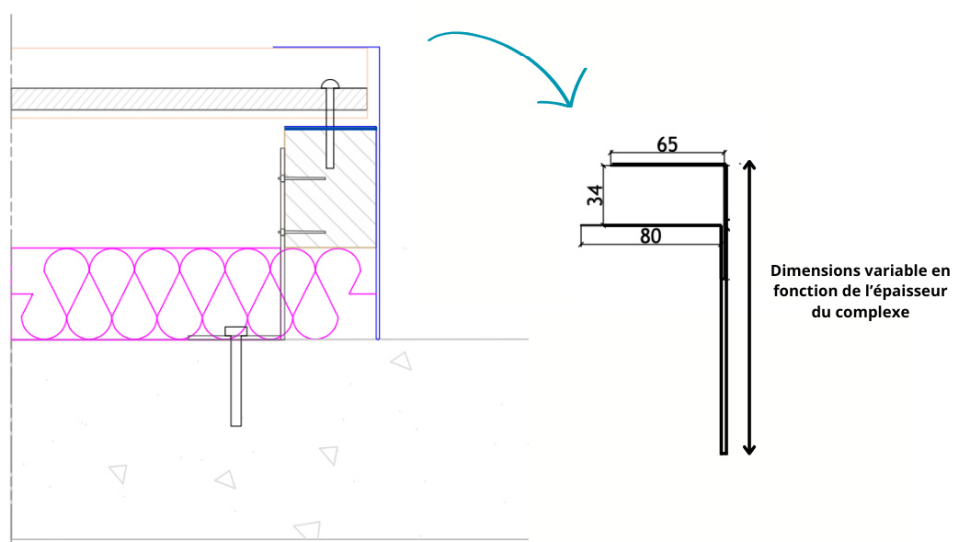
Coupe horizontale sur arrêt latéral sur OB en pose verticale
